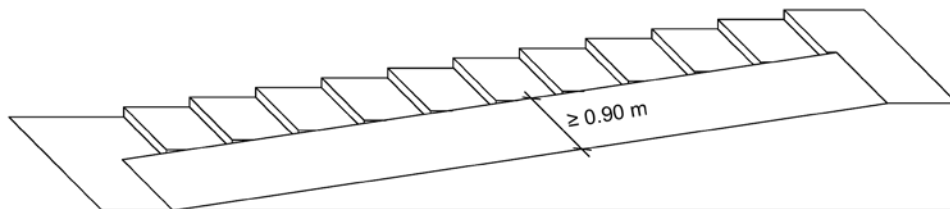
Treppe mit Kinderwagenrampe (nur Rampe)
